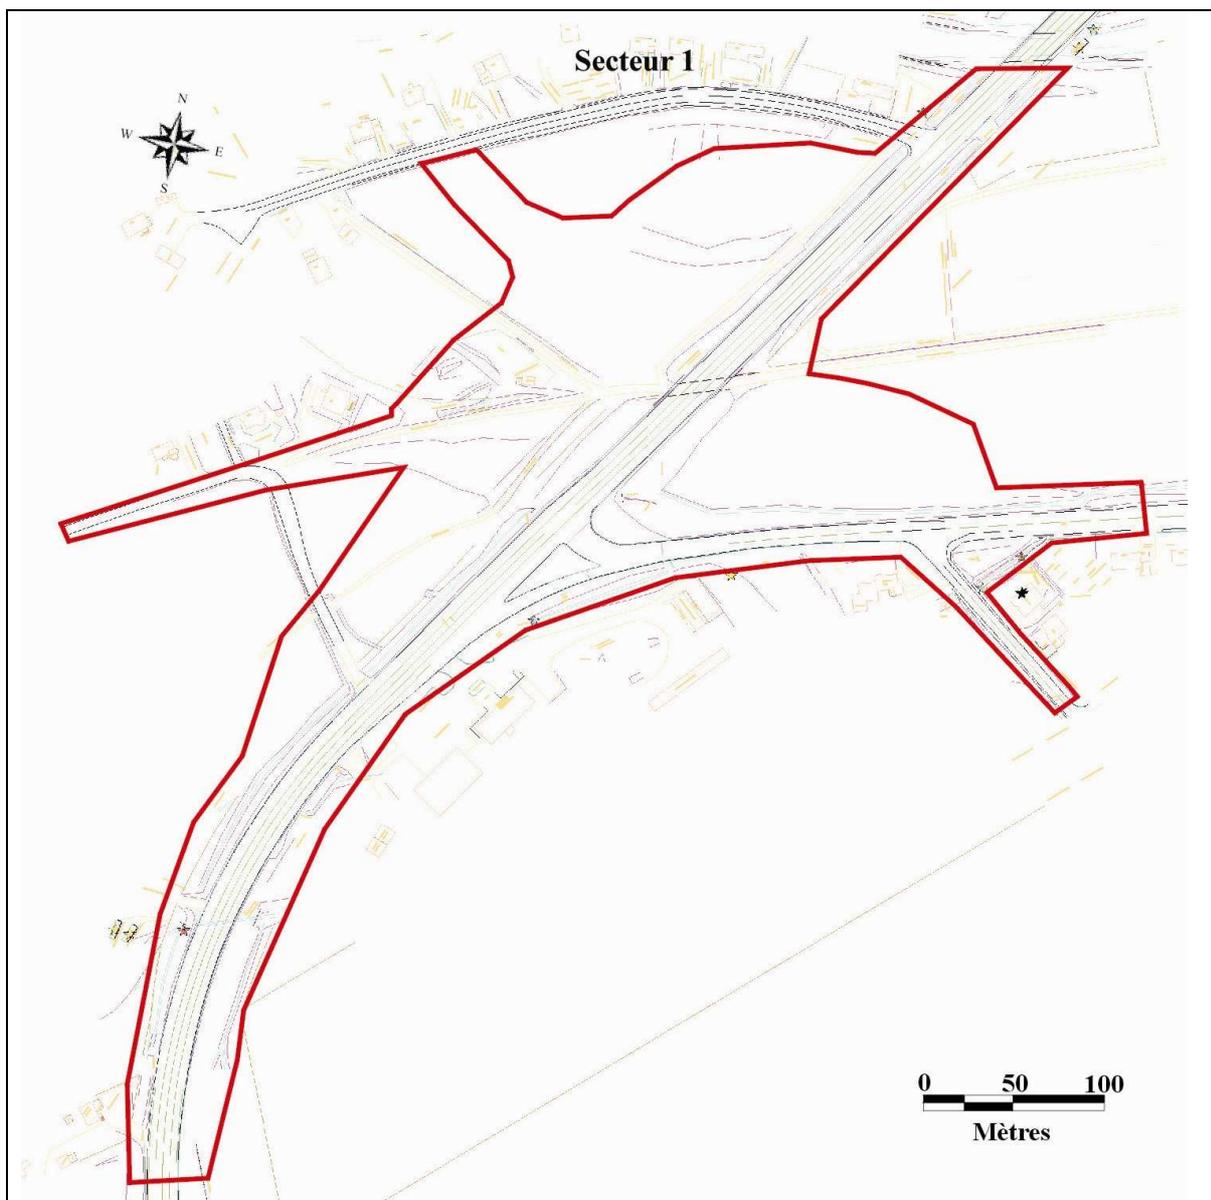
projet 154-94-0590, plan de construction et secteur d'inventaire.
